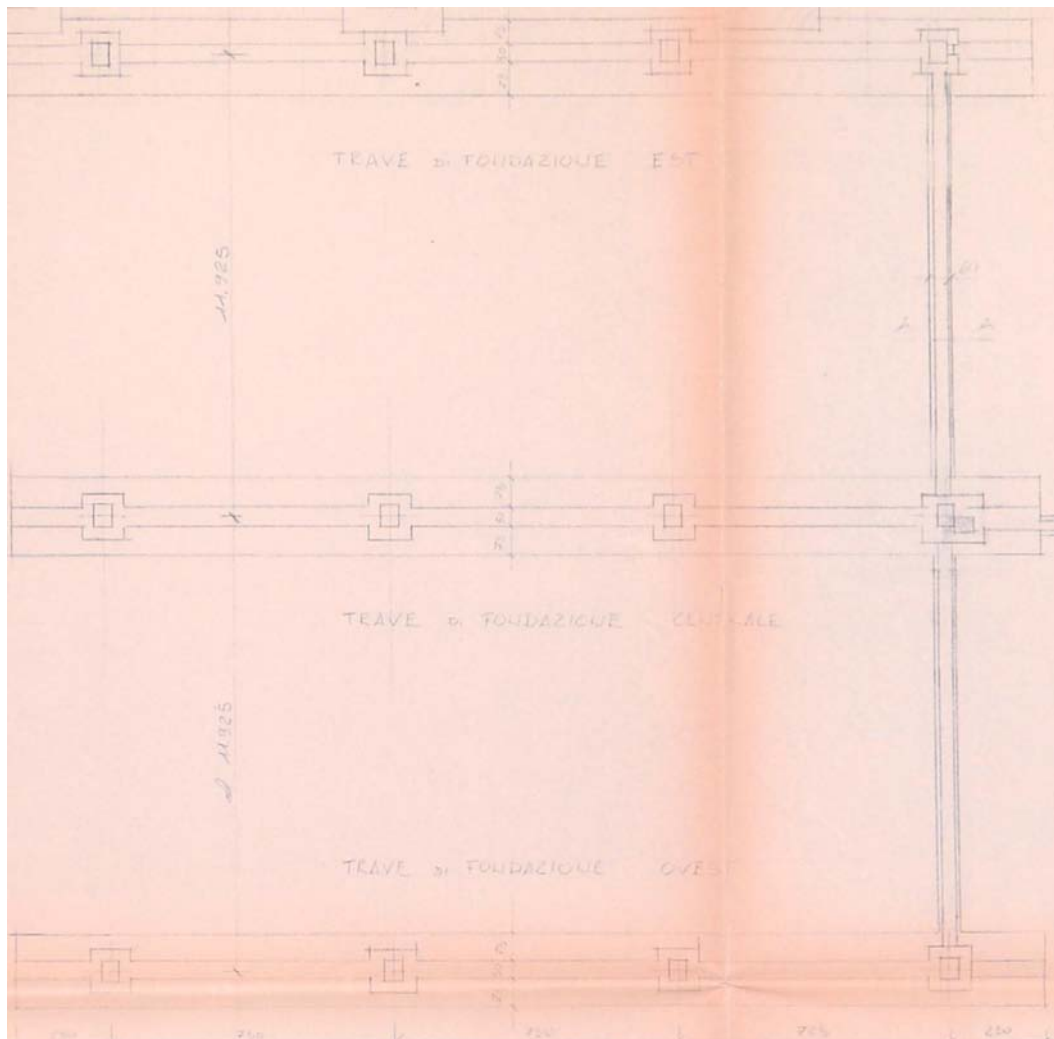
Particolare di A.1990.cap.us.T06 - Pianta delle fondazioni - Fondazioni zona bipiano - porzione M
